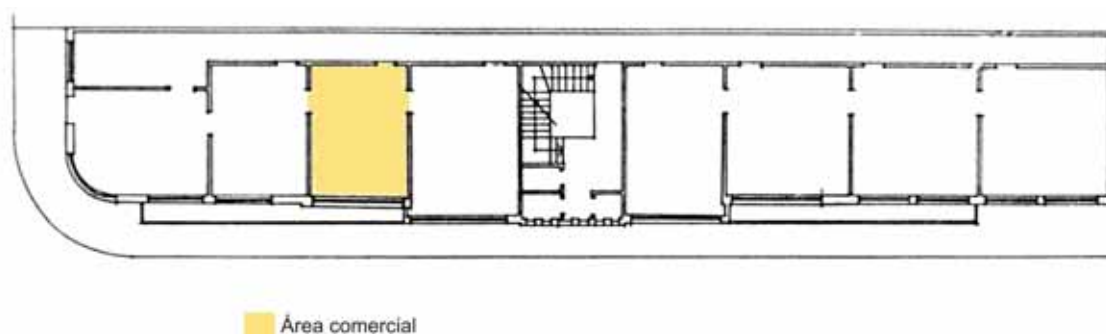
Edifício Palmeiro – planta baixa pavimento tipo, Porto Alegre (1934) – Monteiro Neto. Fonte: MACHADO, 1998, op. cit., p.426, vol.02.
